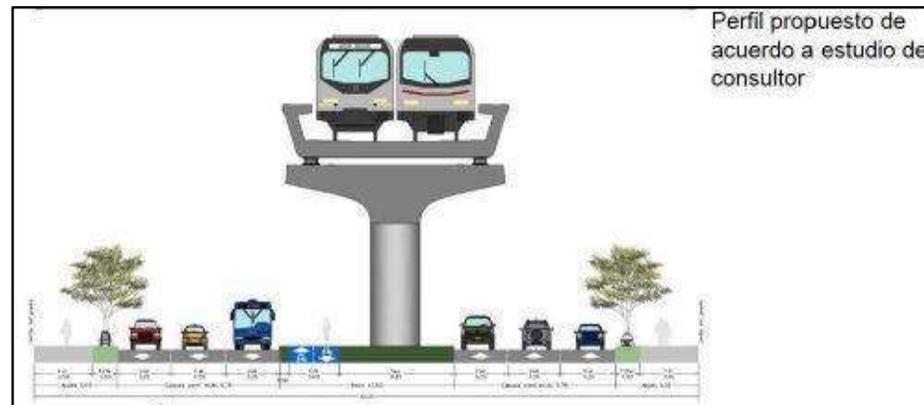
Perfil propuesto Av. 1° de Mayo.
